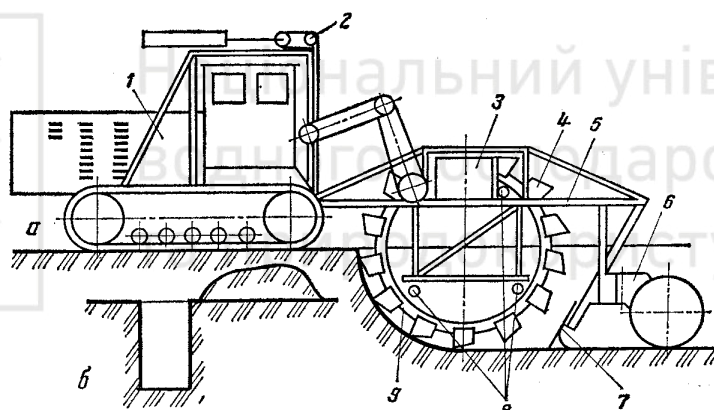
Схема траншейного роторного екскаватора: *a* - загальний вид; *б* - переріз траншеї; 1 - тягач; 2 - механізм підйому робочого органу; 3 - конвеєр; 4 - ковші; 5 - рама робочого органу; 6 - задня опора; 7 - зачисний щит; 8 - підтримуючі та направляючі ролики; 9 - ротор
